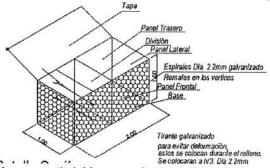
Detalle del Gavión que constituirá los muros de protección en el margen derecho del Río Guatapurí. 11(sie)
